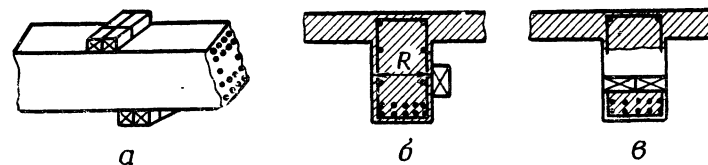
Расположение заряда на железобетонном элементе кон-
